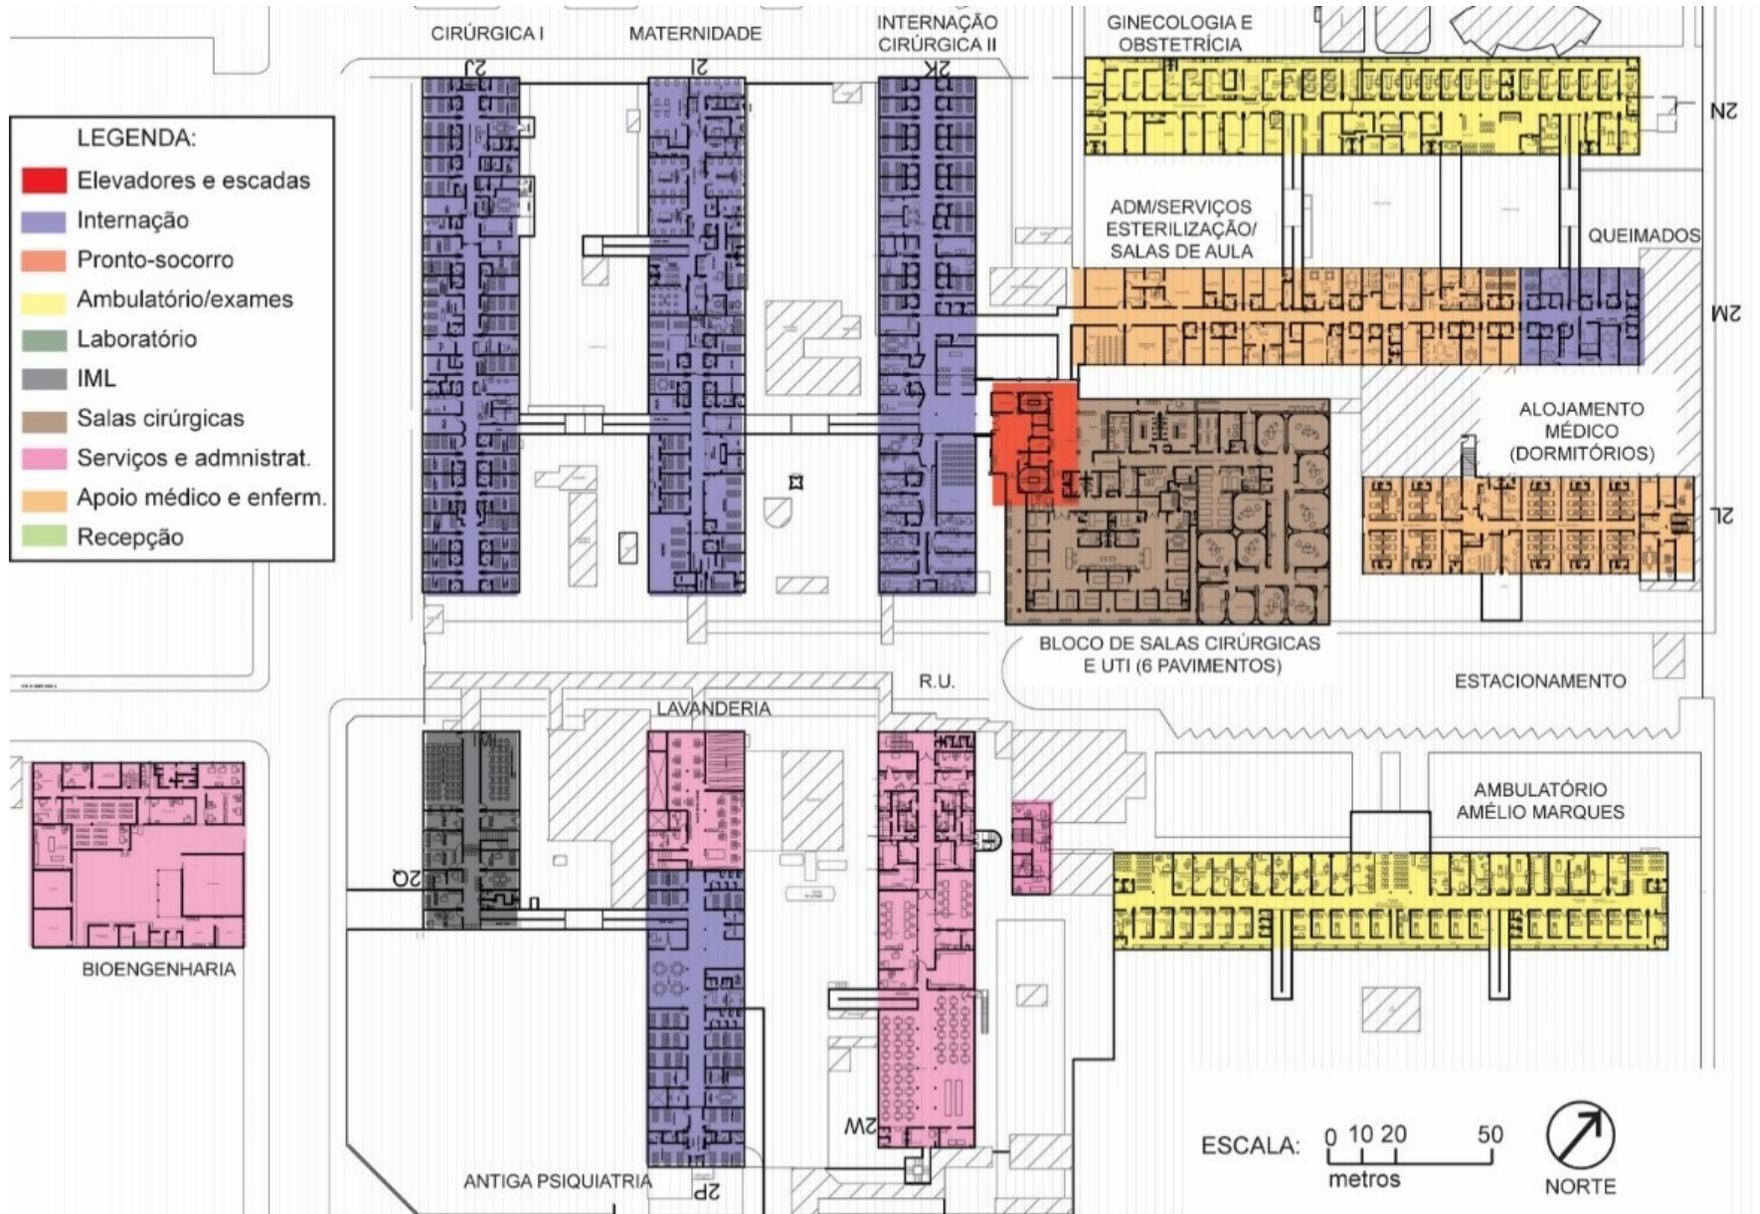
Primeiro Pavimento Hospital da UFU. Fonte: Fonte: Autor e planta do acervo Bioengenharia.
